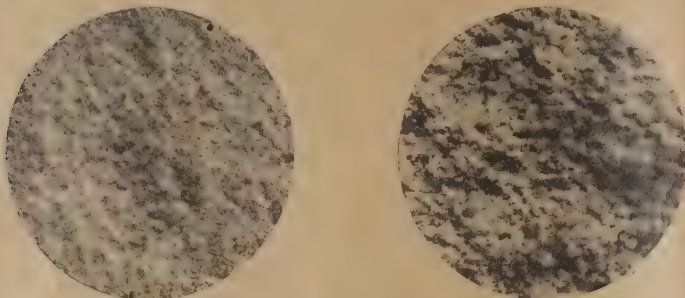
Gußbeton- und Stampfbetonwürfel.
